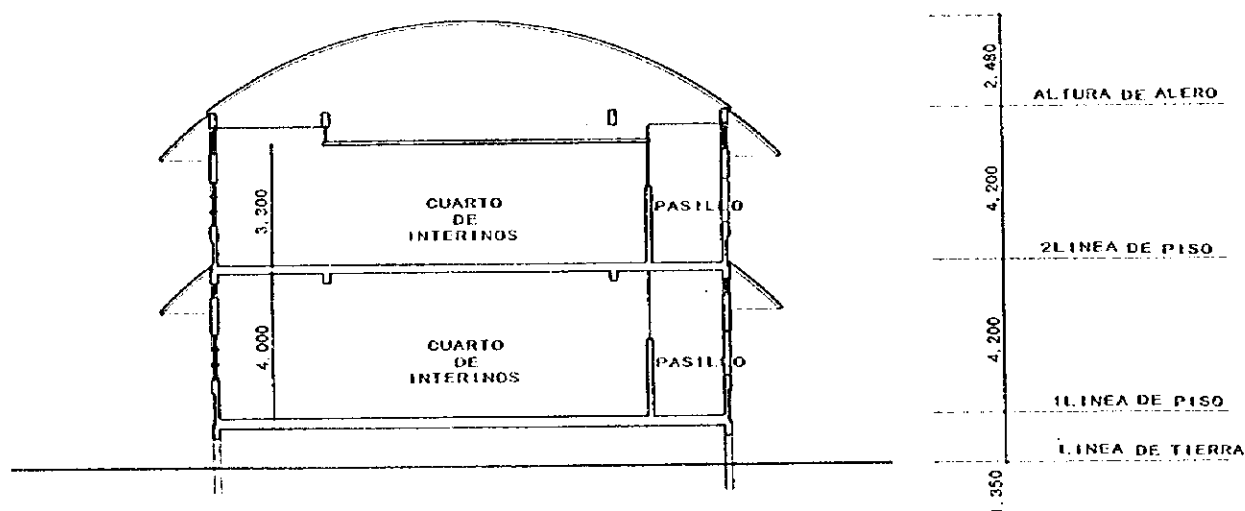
Plano del plan de corte transversal de reconstrucción de residencia de hombres
